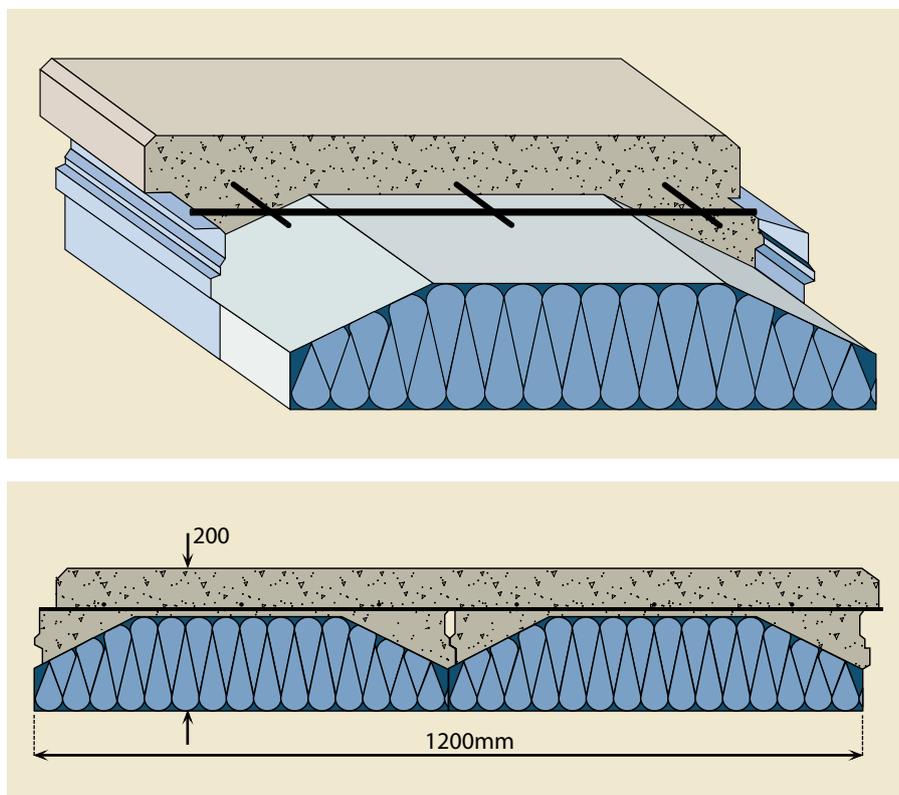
Vue et section transversale d'un élément de dalle Cofradal 200
